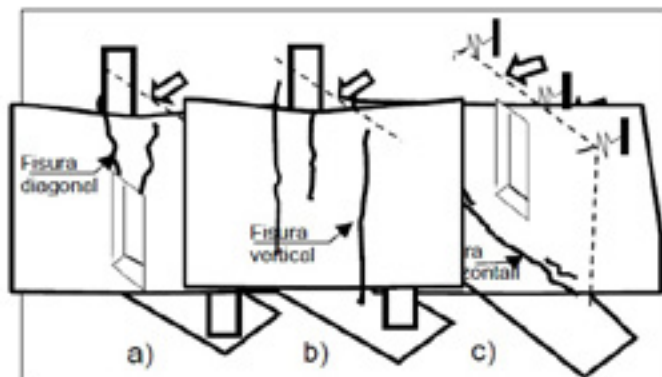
Esquema de muro deformado por sismo y trazas de agrietamientos típicos por flexión y cortante: a) y b) Fisuras verticales en muros arriostrados lateralmente por muros normales (con y sin aberturas); c) Fisuras horizontales en muro apoyado lateralmente en las estructura de entrepiso y/o cubierta
